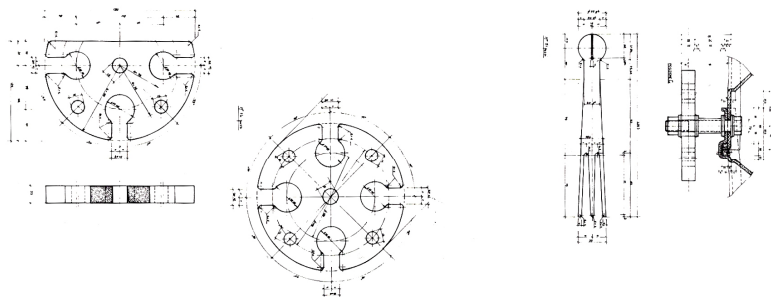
Detalles IMB Traveling Pavilion. Renzo Piano.
